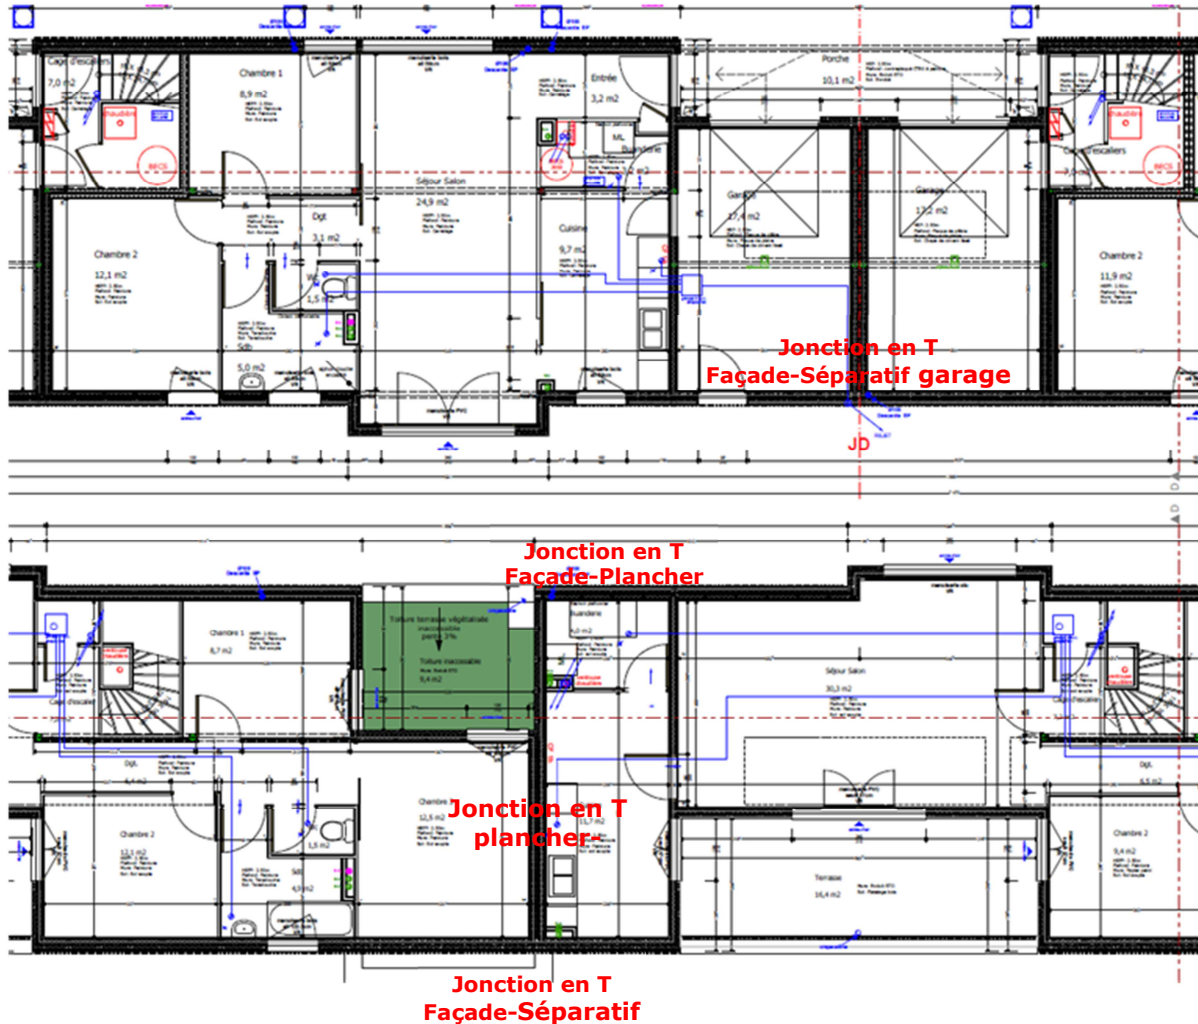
Plan du rez-de-chaussée (en haut) et 1^{er} étage (en bas) et indication des jonctions considérés.
